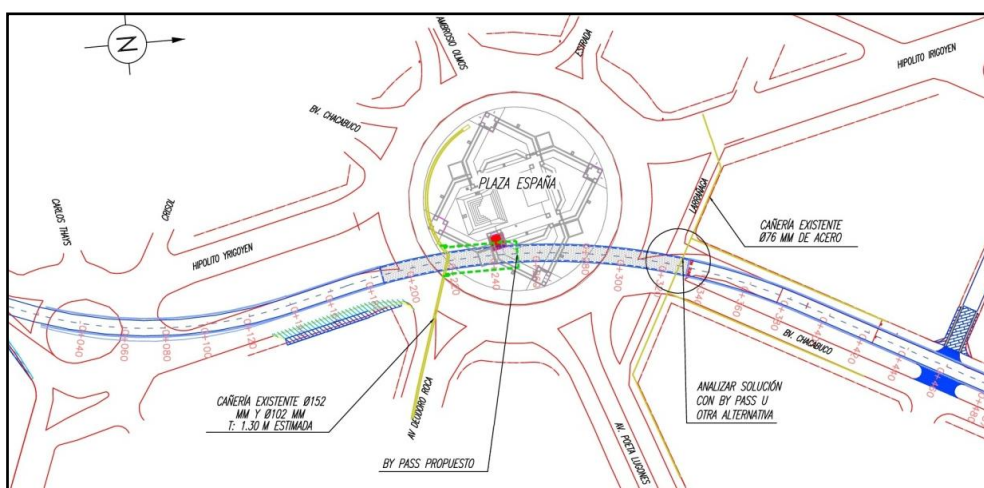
Red de gas existente afectada con proyecto ejecutivo de desvío (plano N°11).
